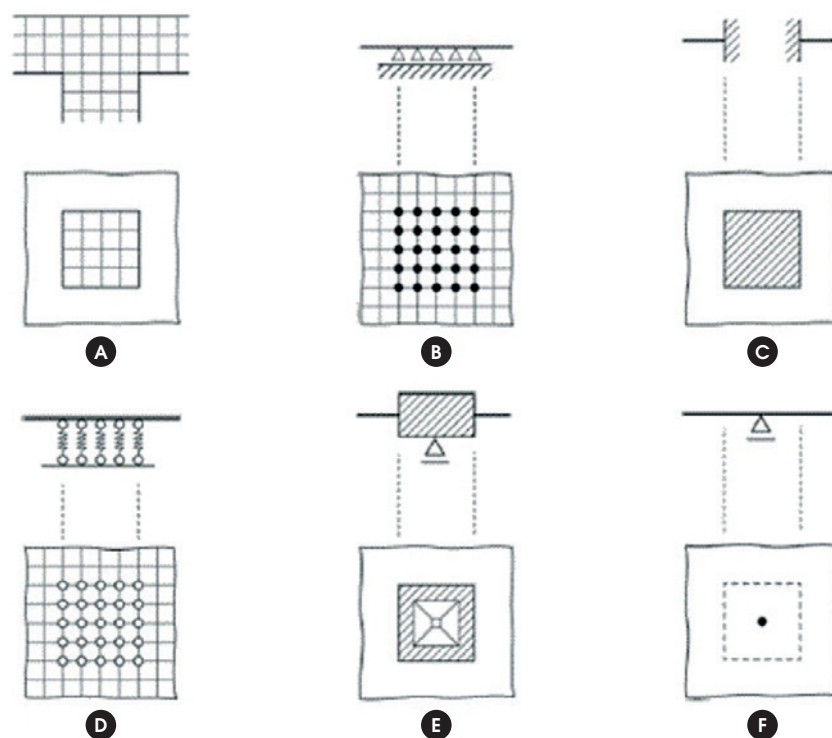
Formas de modelagem da ligação pilar/laje plana (ROMBACH (10))
